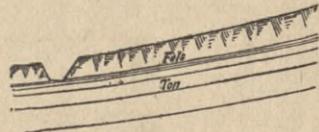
Geneigte Bodenschichtung mit Einschnitt.
